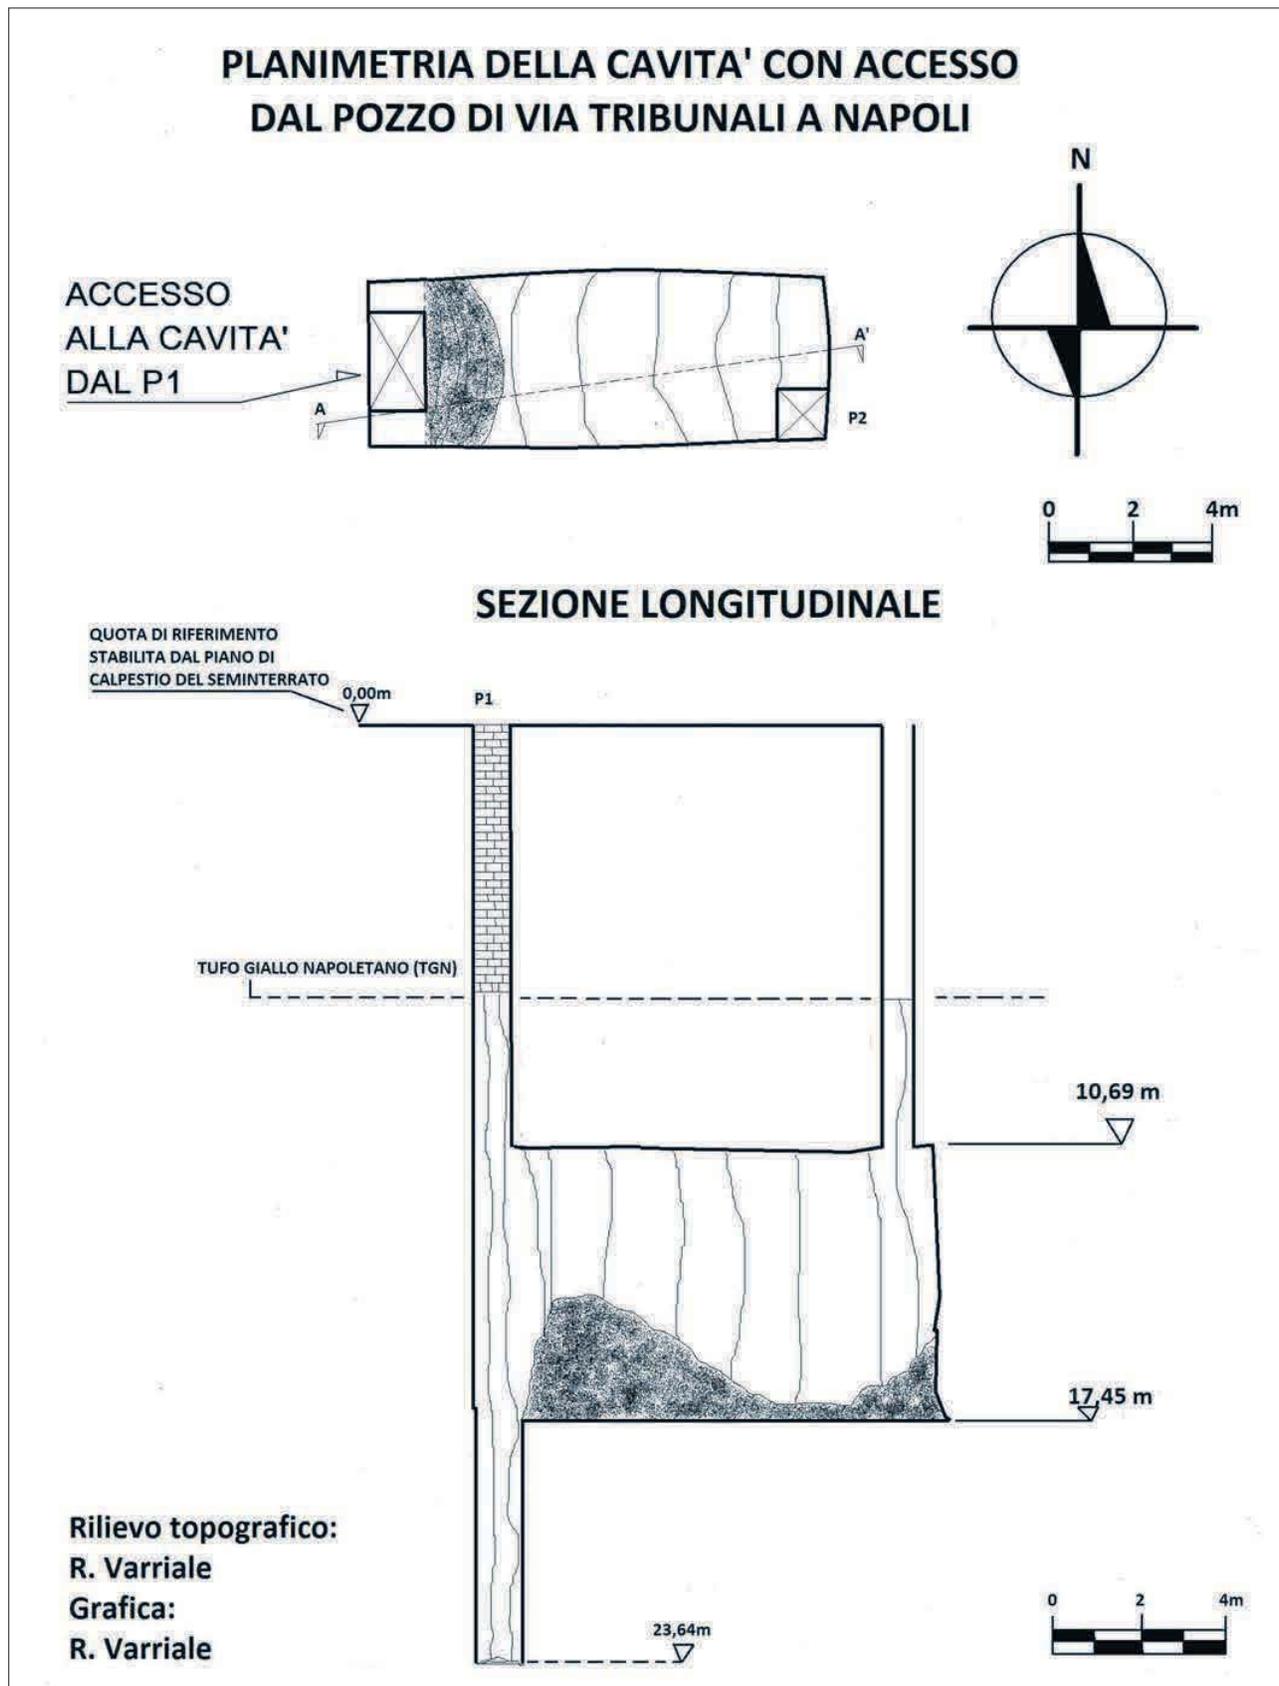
Planimetria del pozzo di via Tribunali e della cavità situata a 10,7 m di profondità (grafica R. Varriale).
